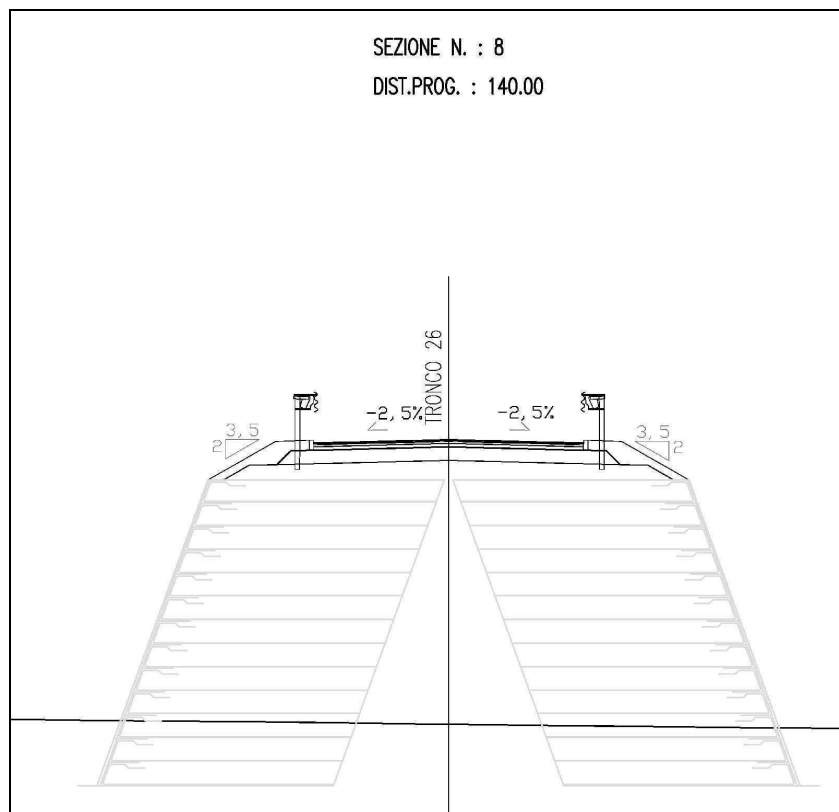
Sezione stradale n. 8 – cavalcavia 4
